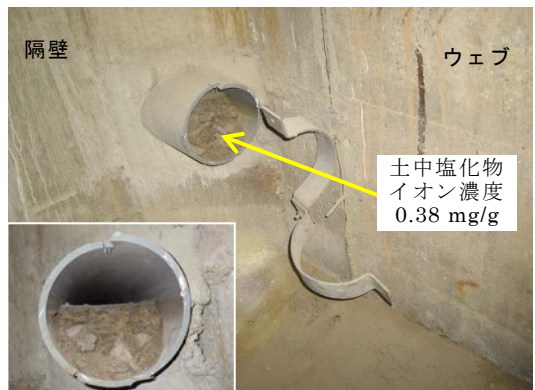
箱桁内部の排水管中の土砂堆積（写真-1と同橋）
